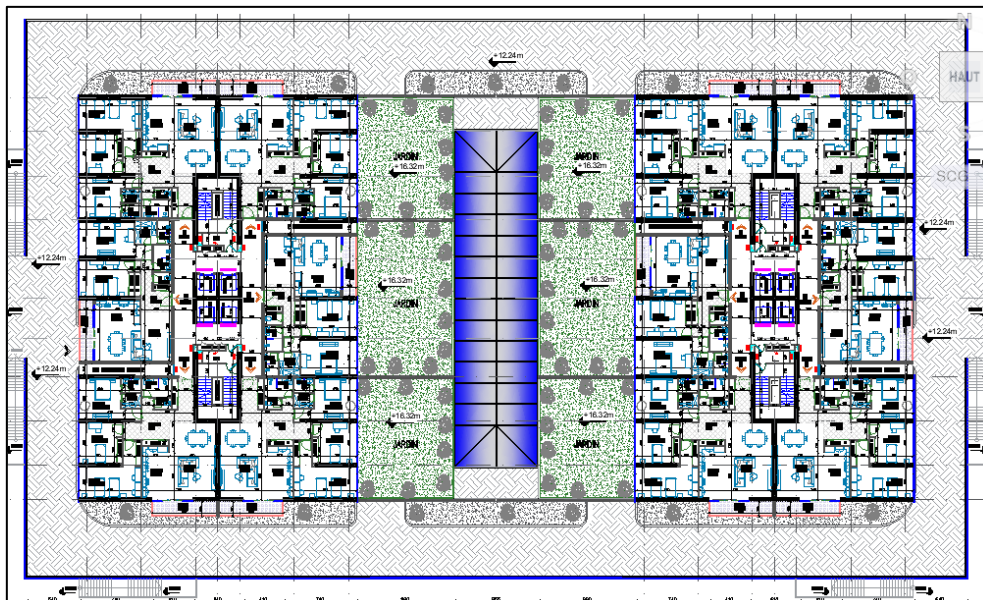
Plan de 4^{ème} étage (logements / esplanade)
